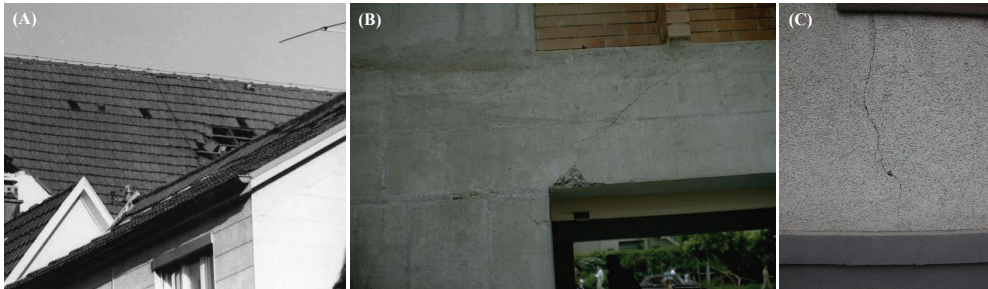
Beispielfotos *leichter* Schäden – global (A) [55], Stahlbeton (B) [134] und Mauerwerk (C) [IMB]
